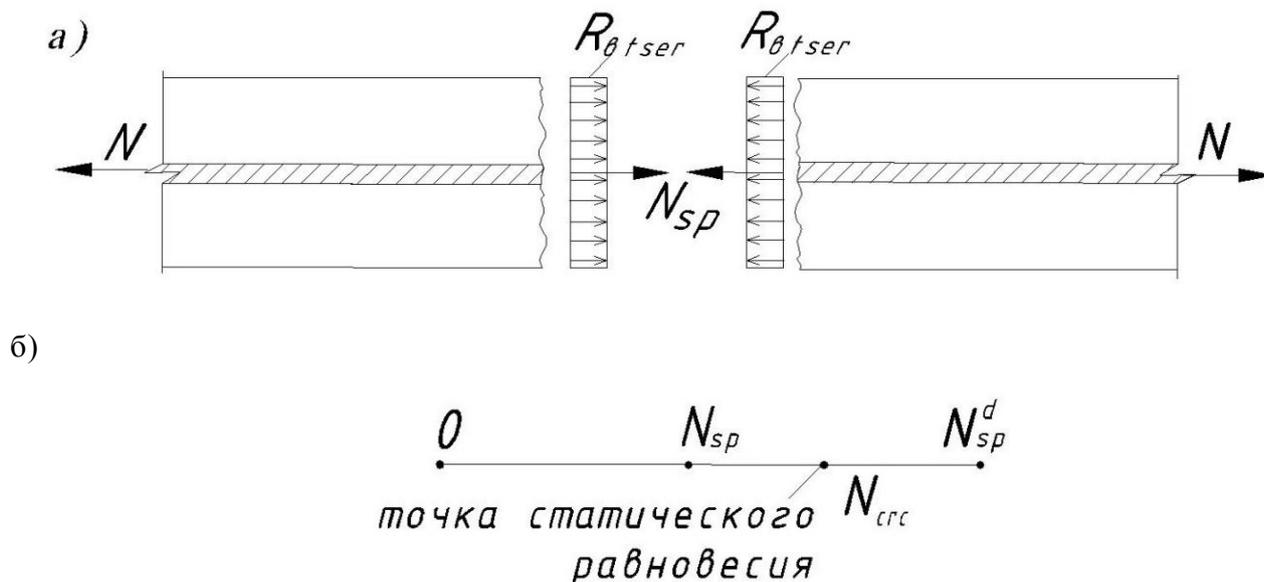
К расчету напряженного состояния в бетоне и арматуре растянутого балочного элемента (а), схема изменения продольной силы в арматуре железобетонного изгибаемого элемента (б)
